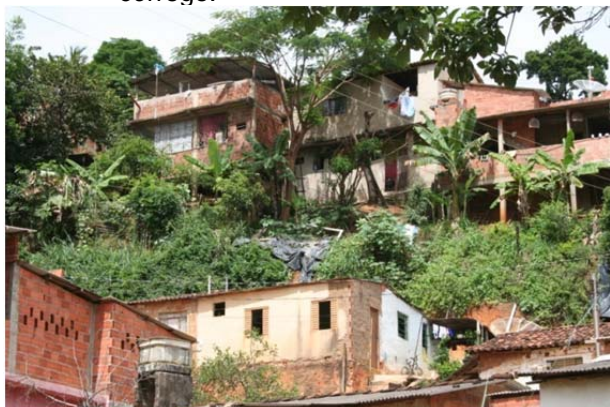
Ligações prediais passando pelo lote do fundo e sendo interligado na rede da rua abaixo.
